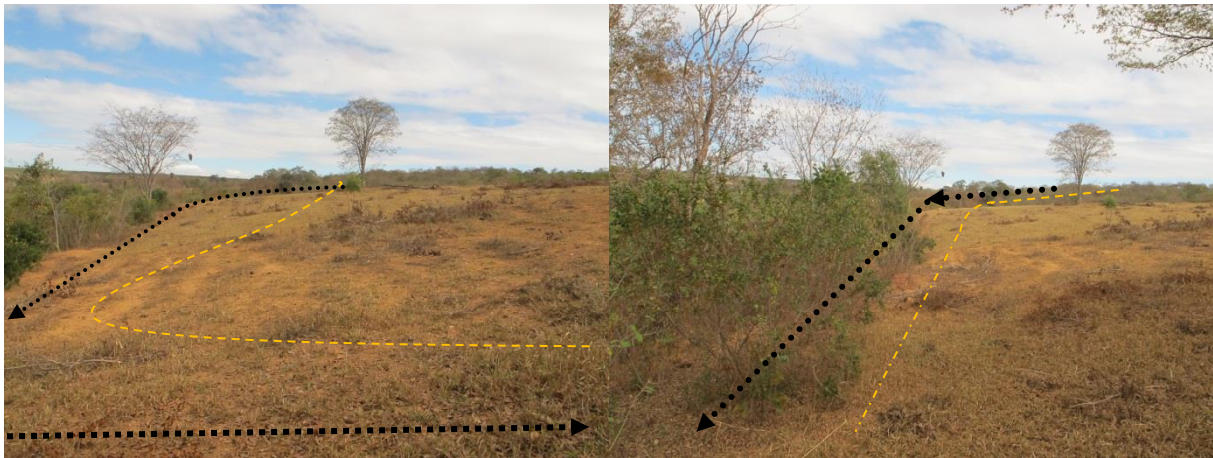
Vista de jusante da voçoroca. As setas tracejadas ilustram os locais das seções a serem construídas as paliçadas, sendo a seta em primeiro plano com a sessão de 4,0 m e a seta de segundo plano a sessão de 3,0 m. (Coord. UTM 552651 / 793135288).
